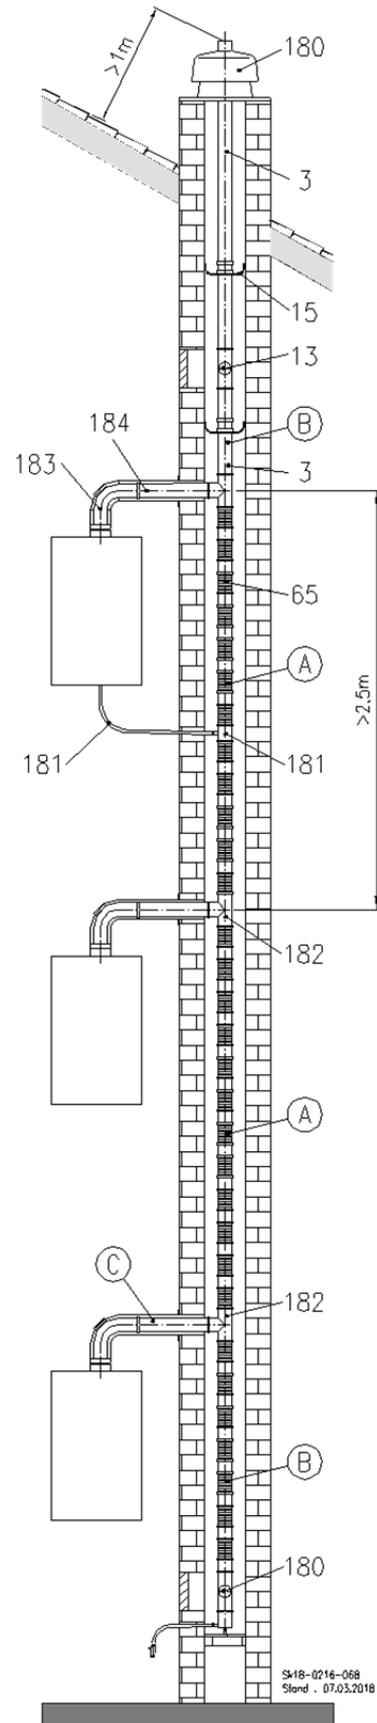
C_{43x} Installation multiple dans canal de cheminée (voir page suivant pour légende)
